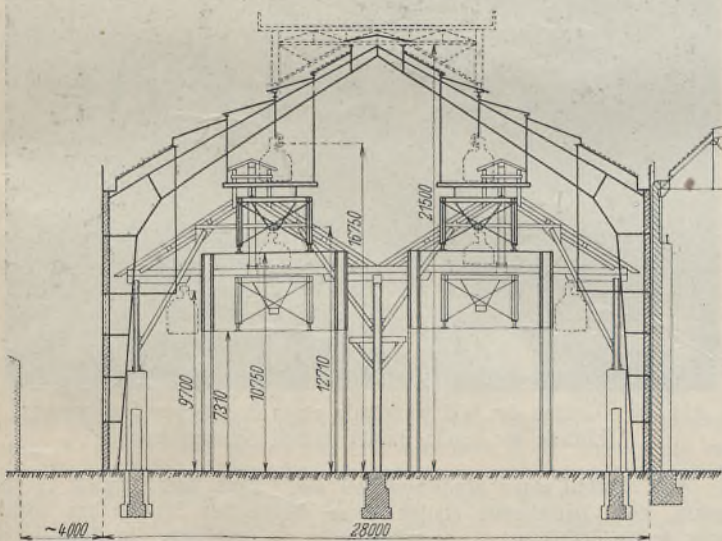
Röstofenhalle der Kupferhütte Duisburg. (Querschnitt der alten und umgebauten neuen Halle.)
